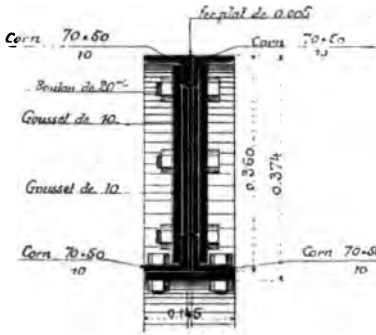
Coupe d'un cintre sur l'assemblage.
